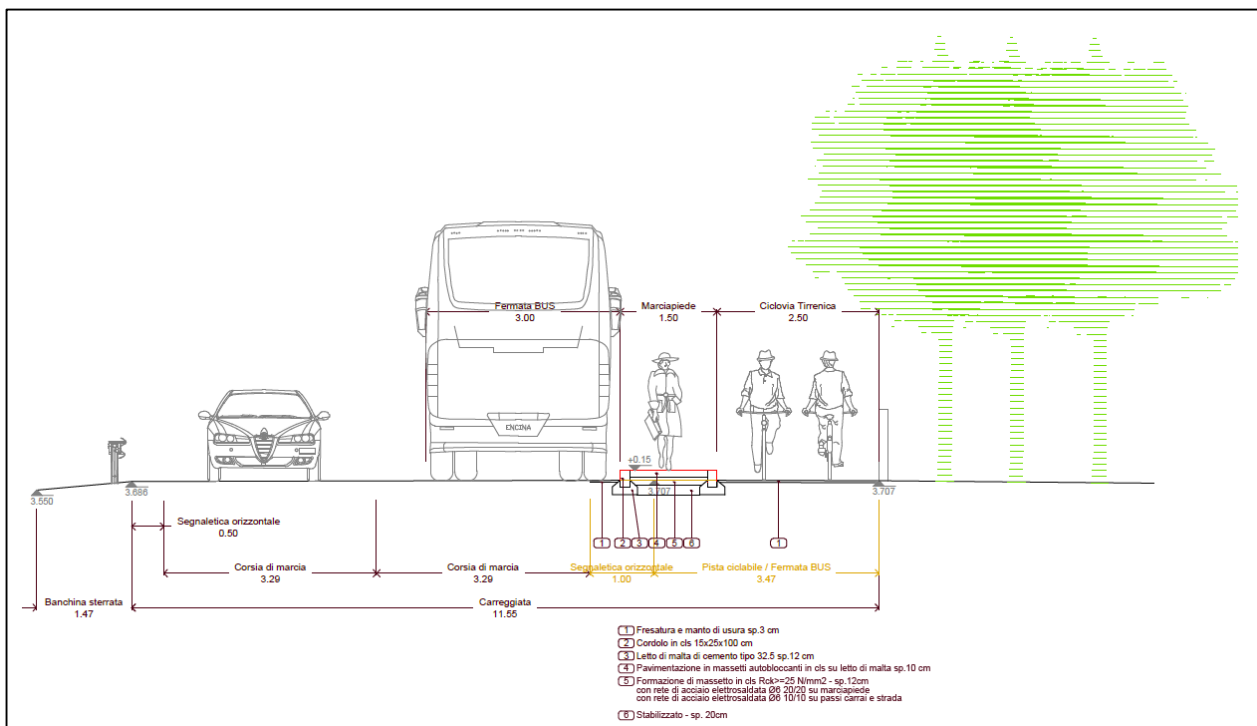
Sezione 09 di progetto trasversale SP delle Collacchie
